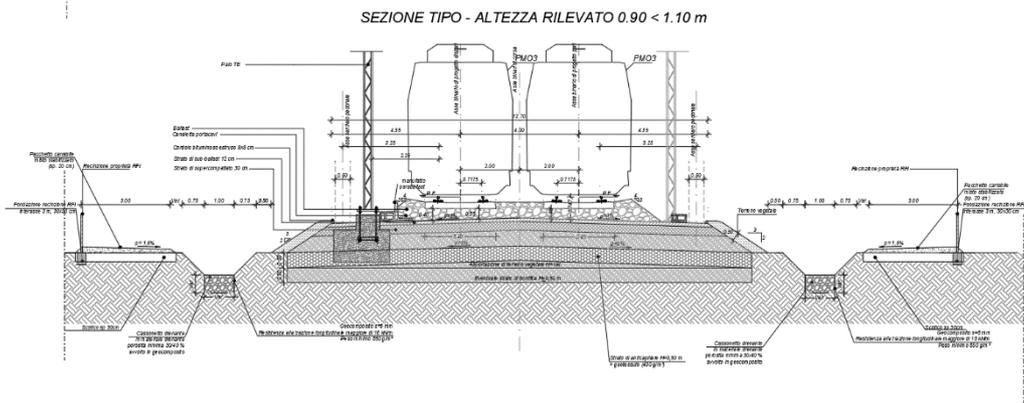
Sezione tipo in rilevato H= 0.90<1.10m
